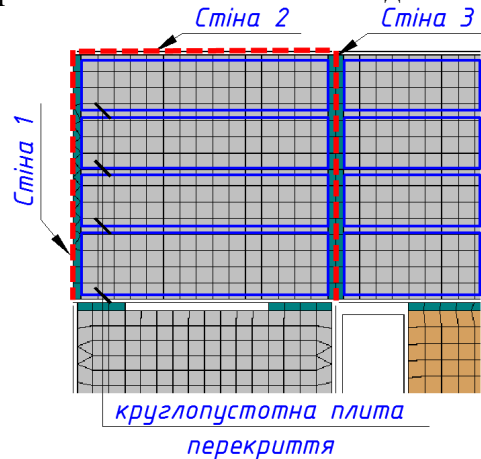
Схема розташування стін 1, 2, 3 та орієнтація круглопустотних плит перекриття.
